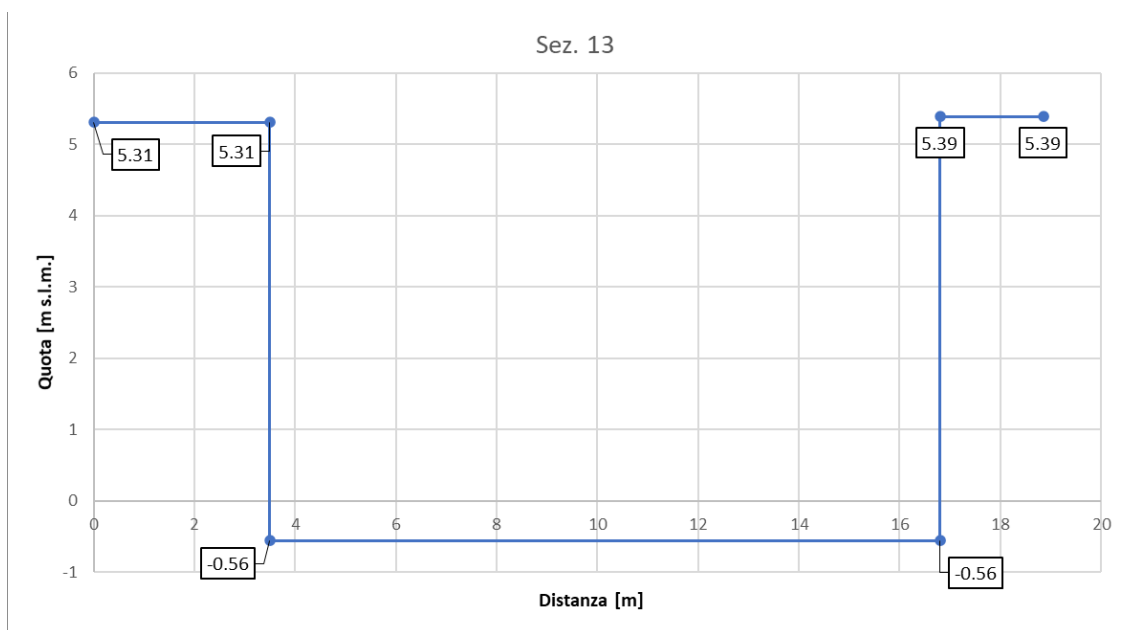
Profilo altimetrico delle sezioni trasversali di progetto
